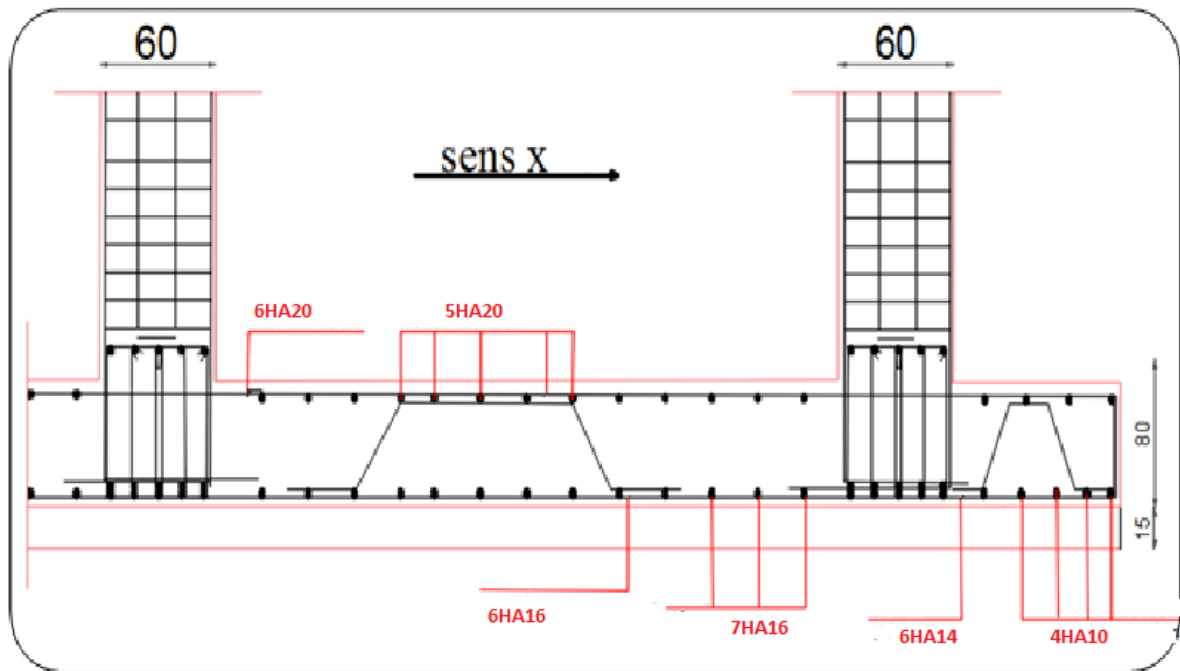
Ferrailage de la Dalle du Radier avec des nervures
